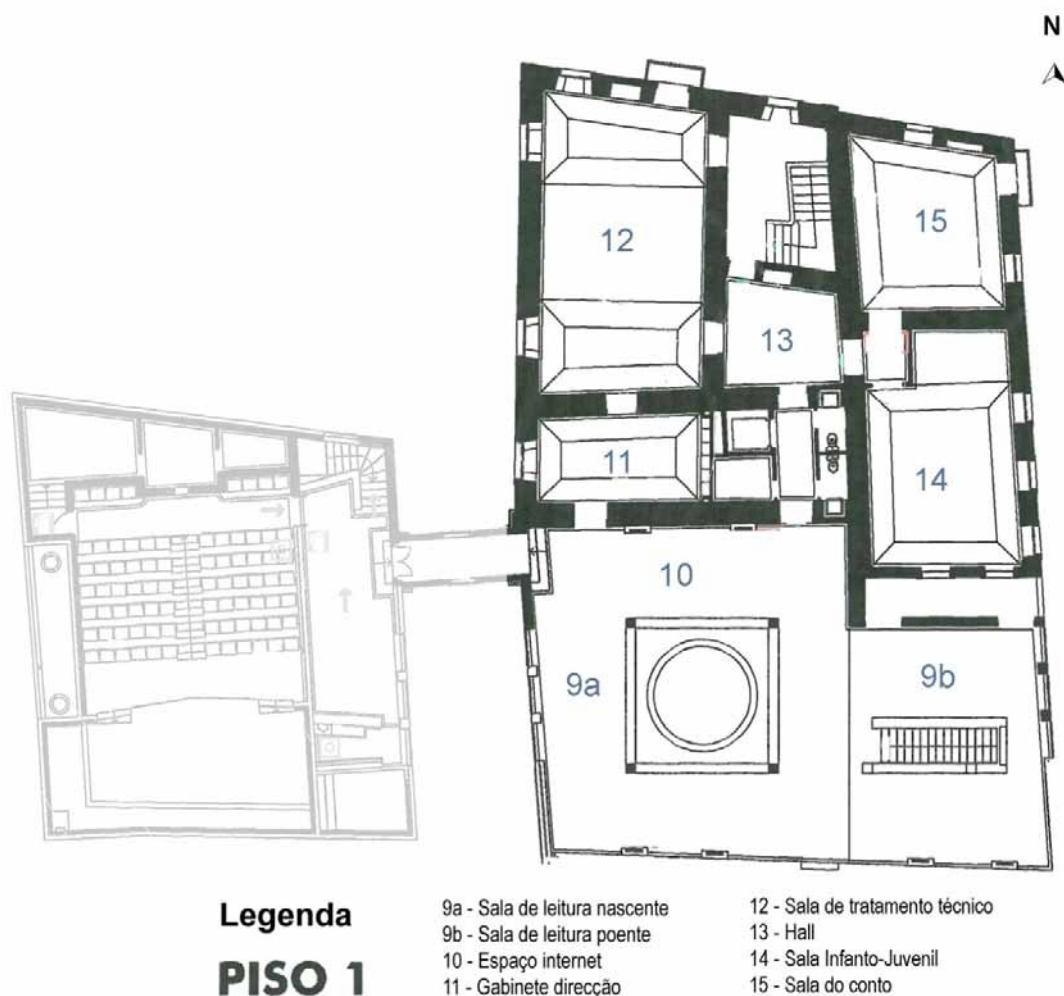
Planta do 1.º andar da BMMB e principais espaços
